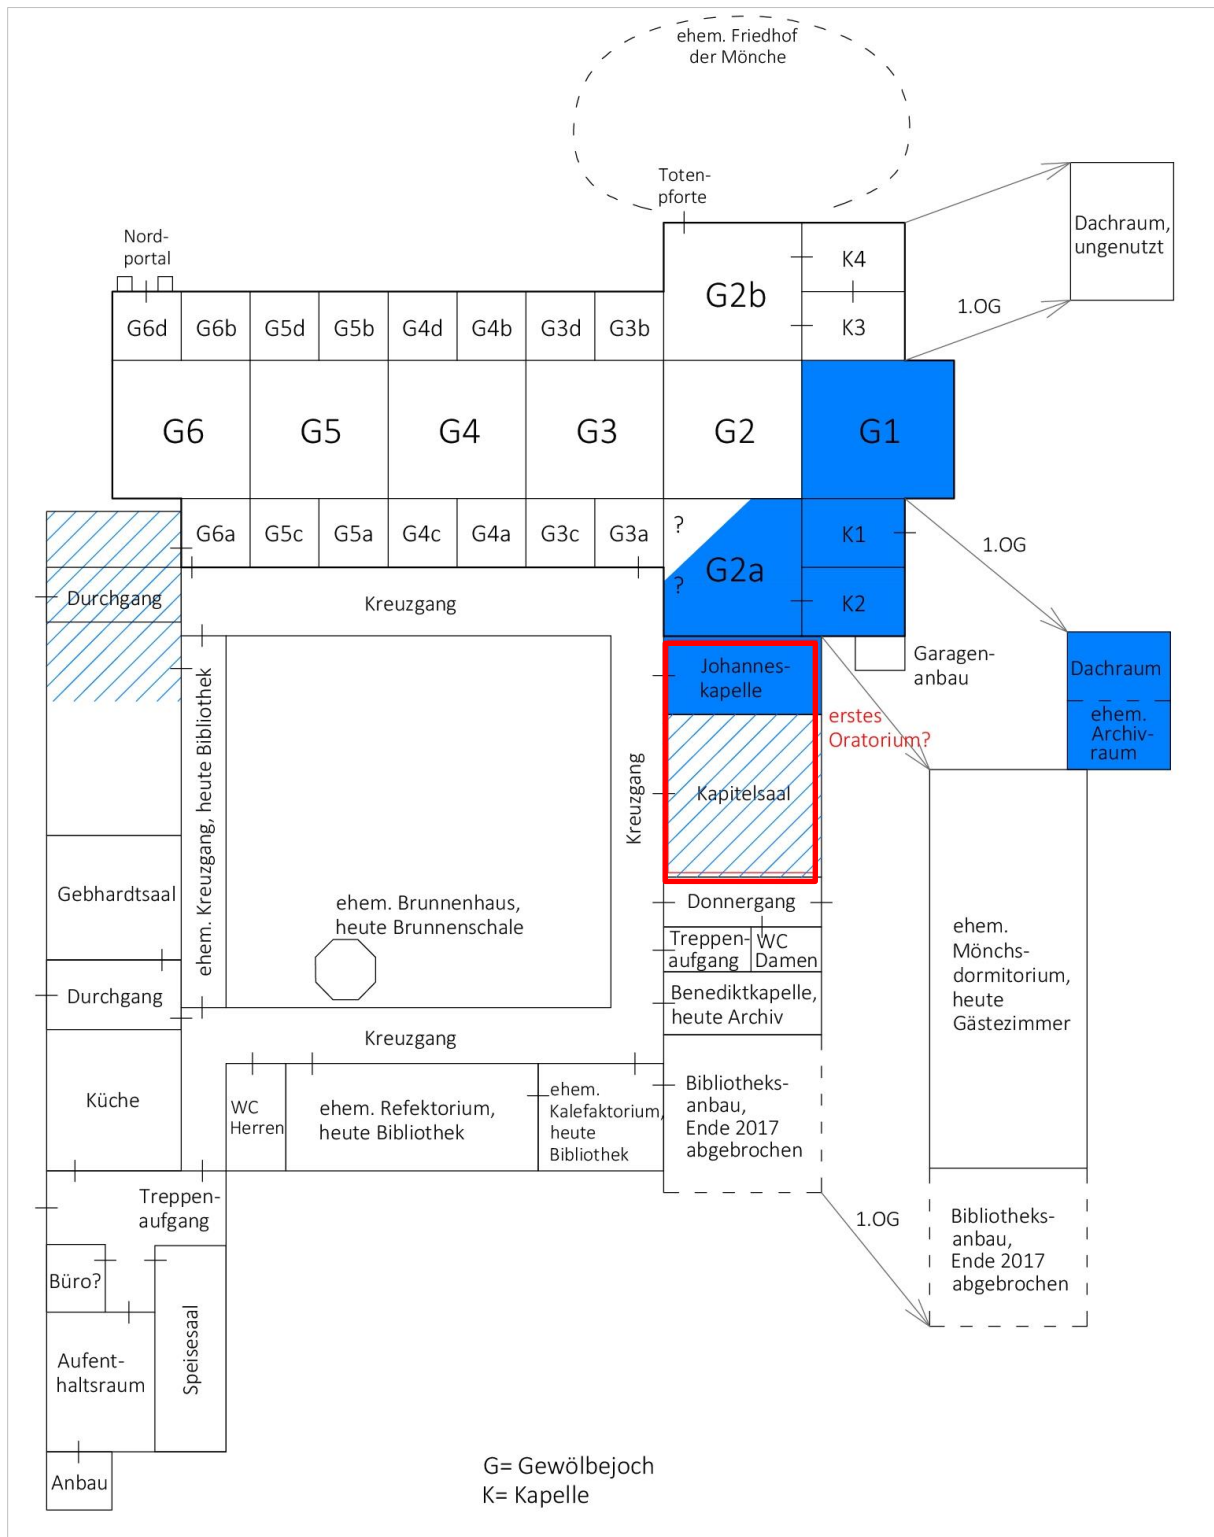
Schematischer Grundriss der Kirche und Klausur, mutmaßlicher erster Bauabschnitt blau, Vermutungen blau schraffiert (J. Eberhard)
